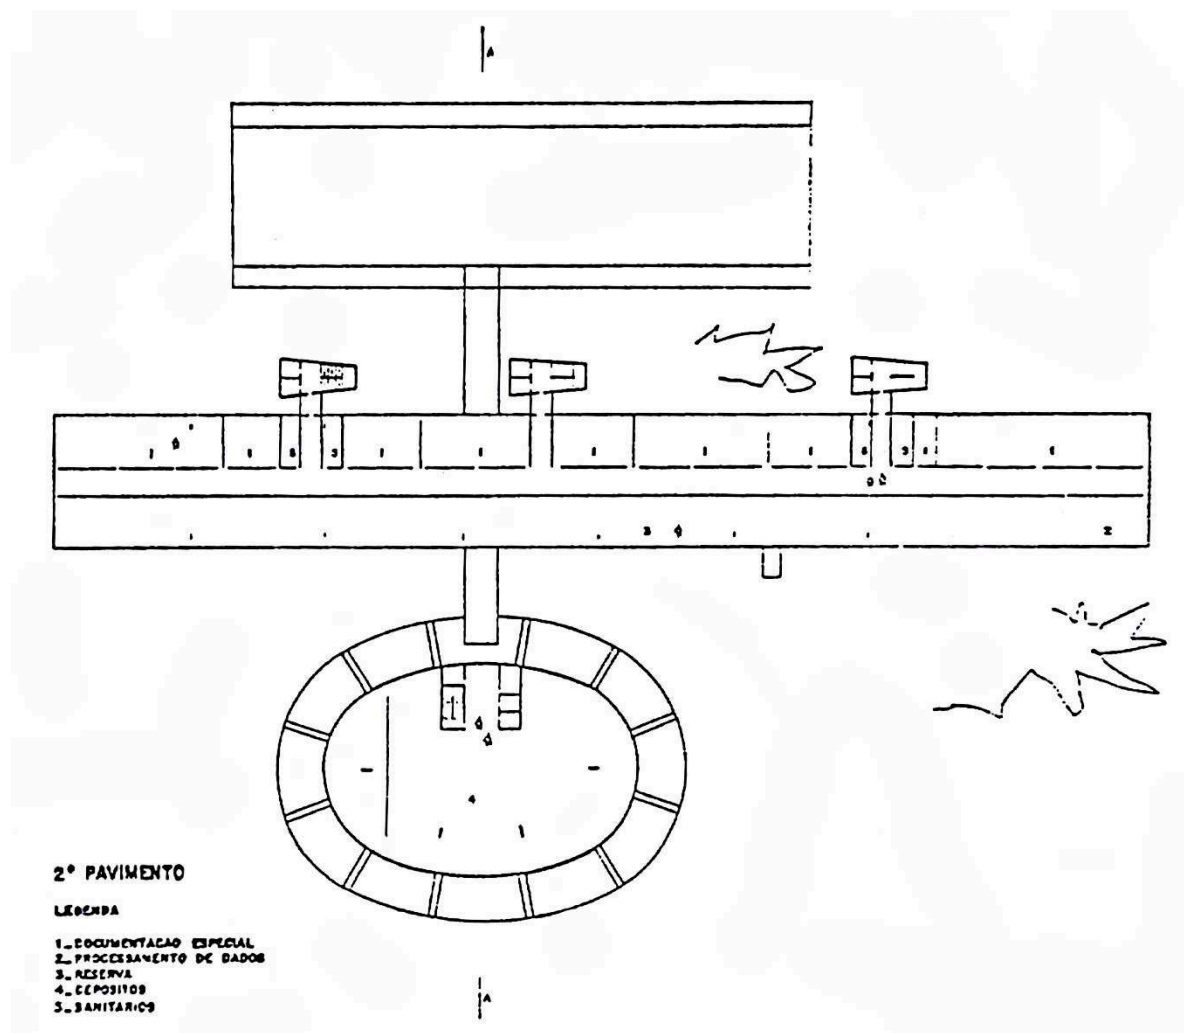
Planta do 2º pavimento do Arquivo Público, 1988-90. Fonte: Arquivo Ministério da Cultura.
